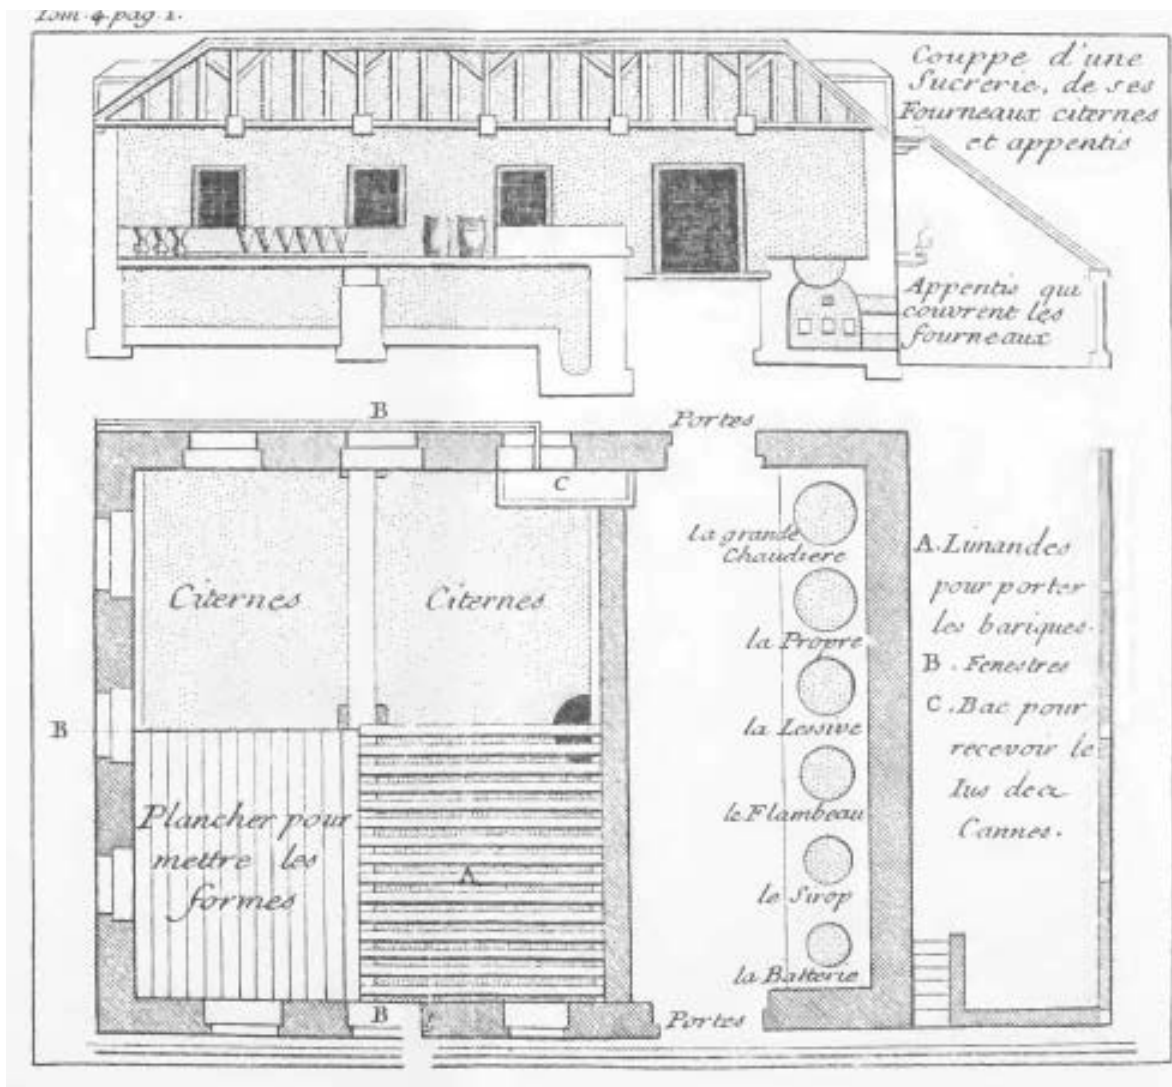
Planta de una sucrerie (Labat 1742b: 1).
